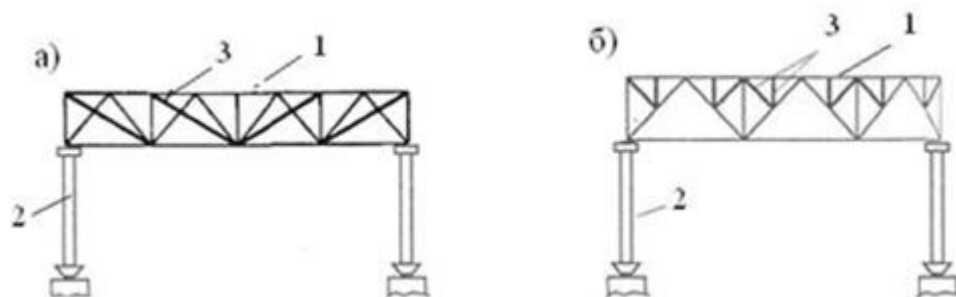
Усиление стропильных ферм путем введения дополнительных элементов решетки (а) или шпренгельных элементов решетки: 1 – усиливаемая ферма; 2 – колонна; 3 – дополнительные элементы решетки
